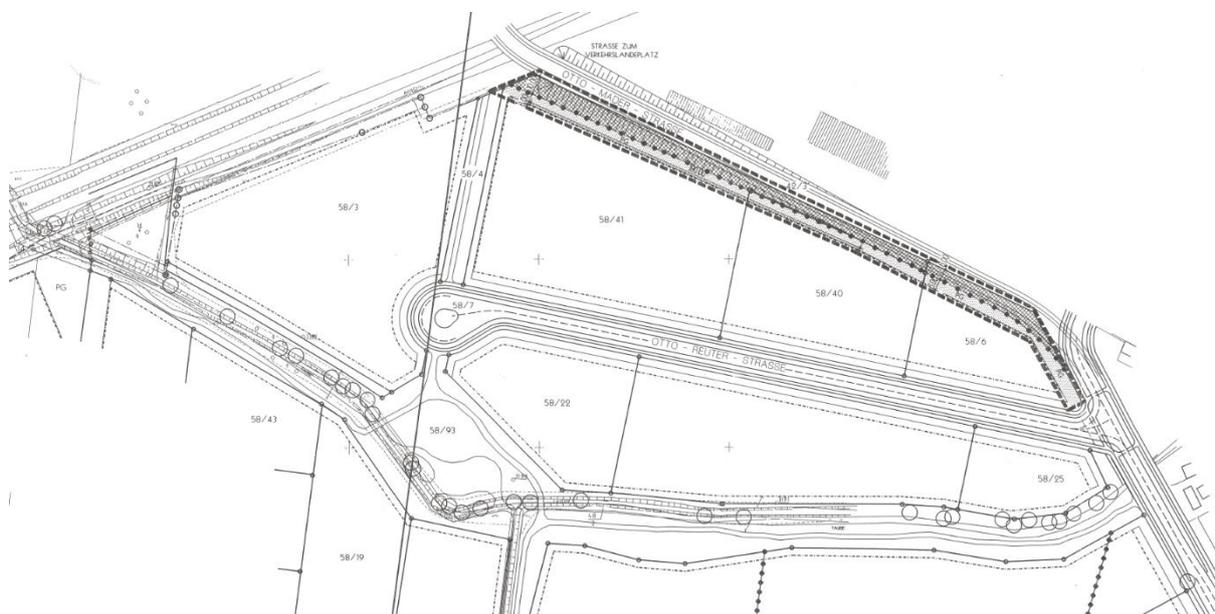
Bebauungsplans 102 1. Änderung, Ausschnitt Planzeichnung 1995
